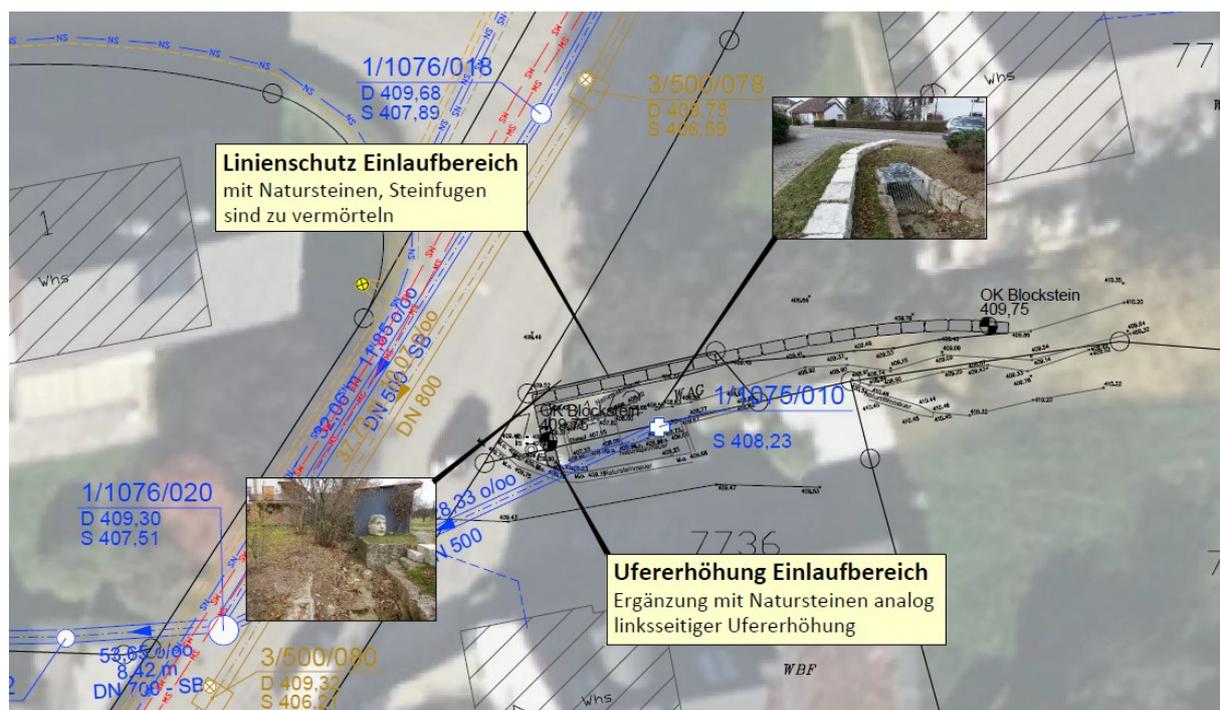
Ausschnitt Lageplan Maßnahmen zur Einlaufoptimierung am Sulzbach
